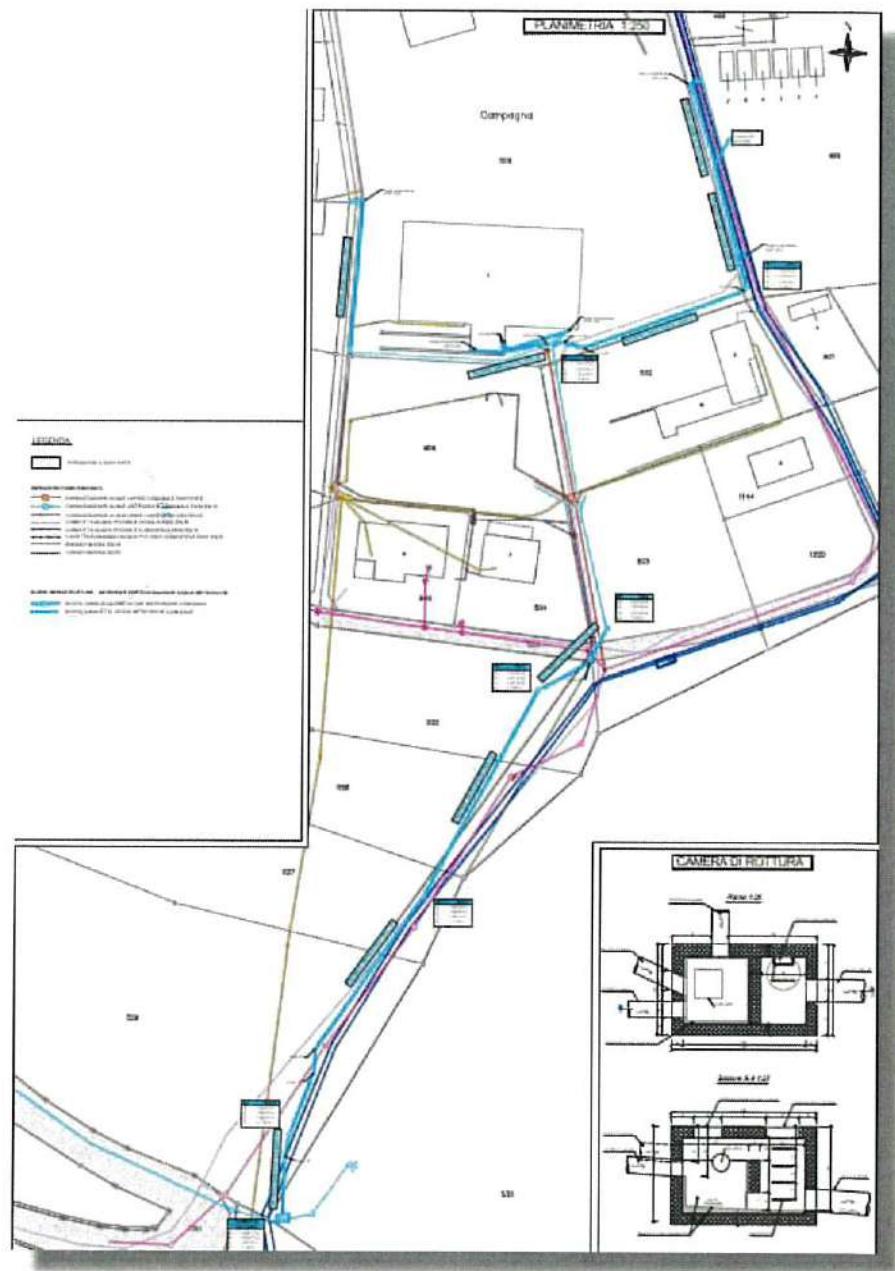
stralcio planimetria conforme all'esecuzione – Tappa 1, piano n°0689-501 (luglio 2020)
